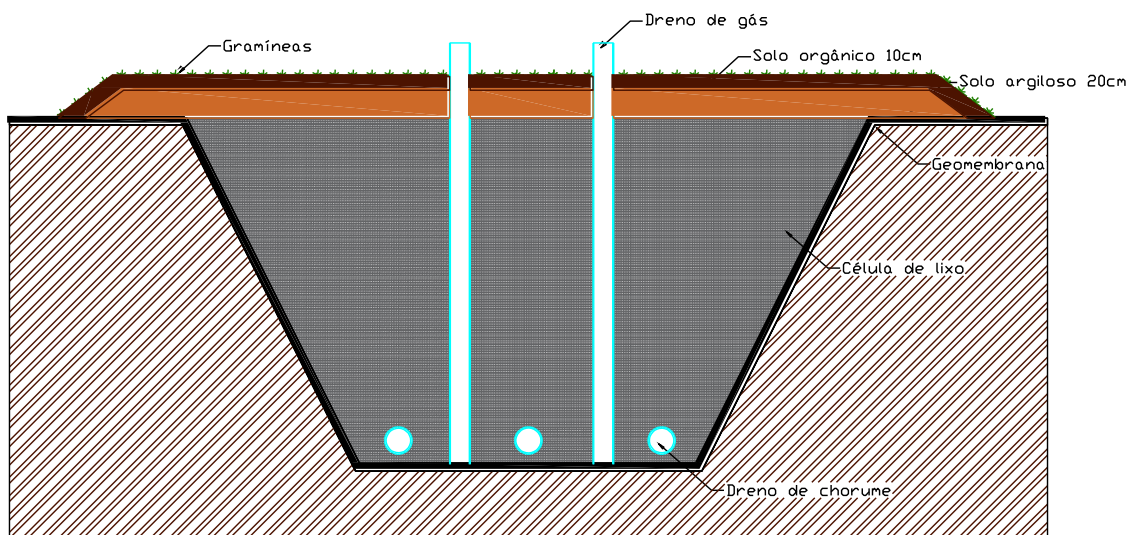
Seção da estrutura da trincheira (AutoCAD/Civil 3D, 2022)
